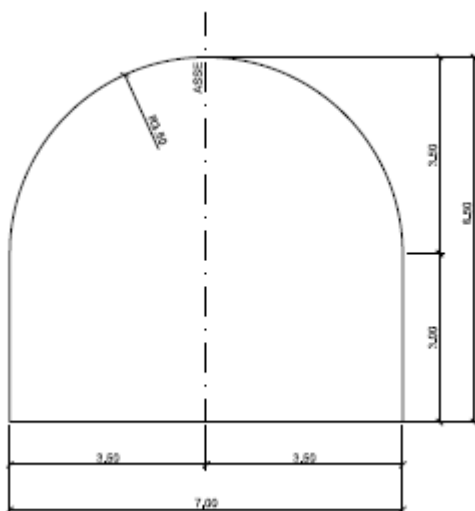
Sezione Analizzata Galleria Di Accesso Al Cantiere Castel San Vincenzo
